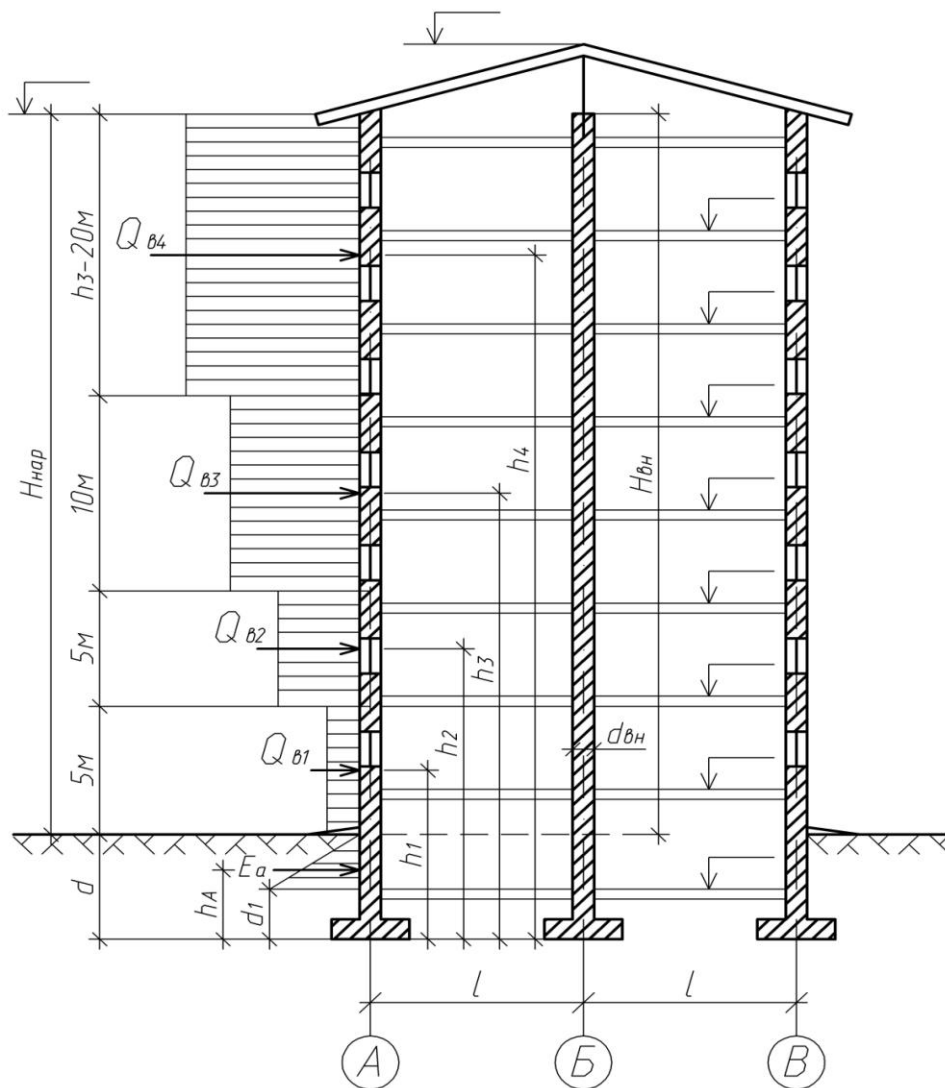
Схема к определению нагрузок на фундаменты
